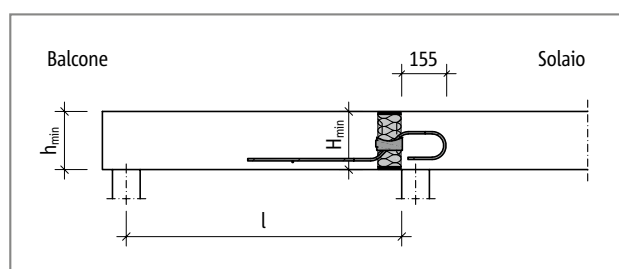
Schöck Isokorb® T tipo QL-V1 - QL-V3: sistema statico
